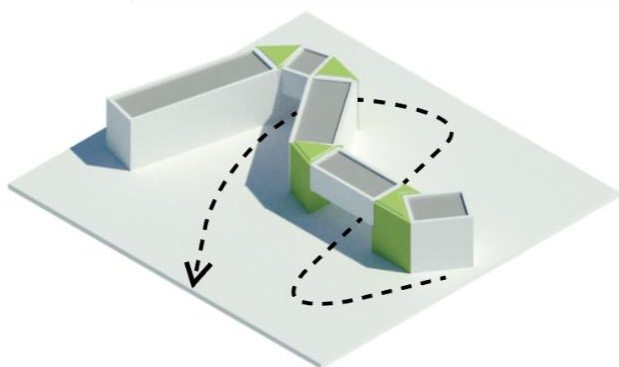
Permeabilidad de equipamiento (planta libre). Fuente: Elaboración propia
